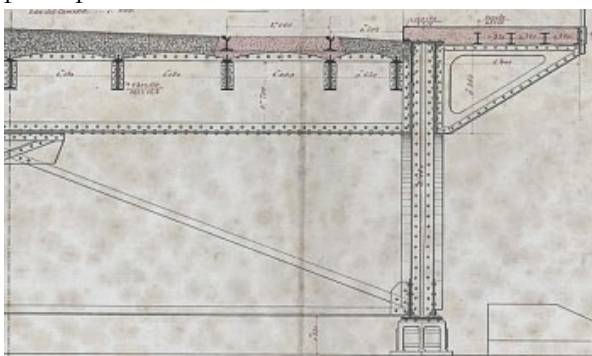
Semi-sección original, con arriostramiento transversal, largueros y pieza del voladizo
